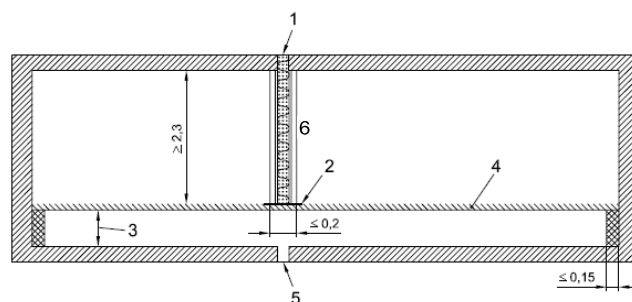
Requisiti della camera di prova [1]: 1) separazione elastica; 2) materiale flessibile; 3) altezza pavimento; 4) pavimento; 5) separazione elastica; 6) parete divisoria.
